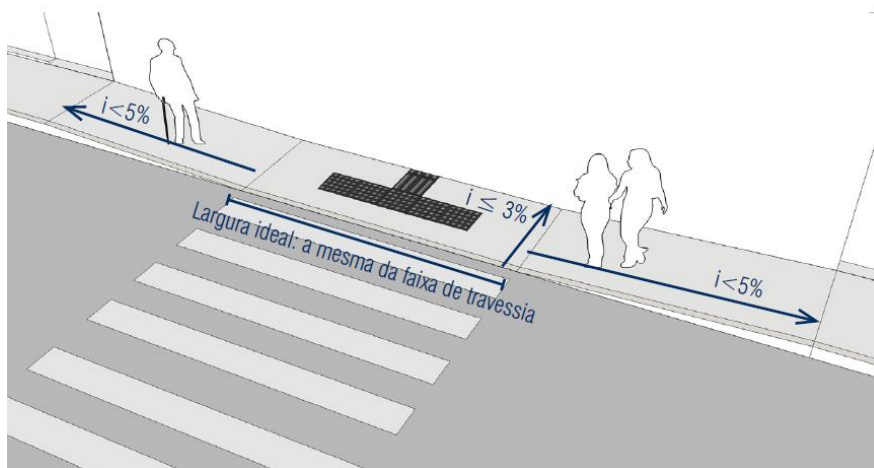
REBAIXAMENTO TOTAL DA CALÇADA COM RAMPAS LATERAIS.
